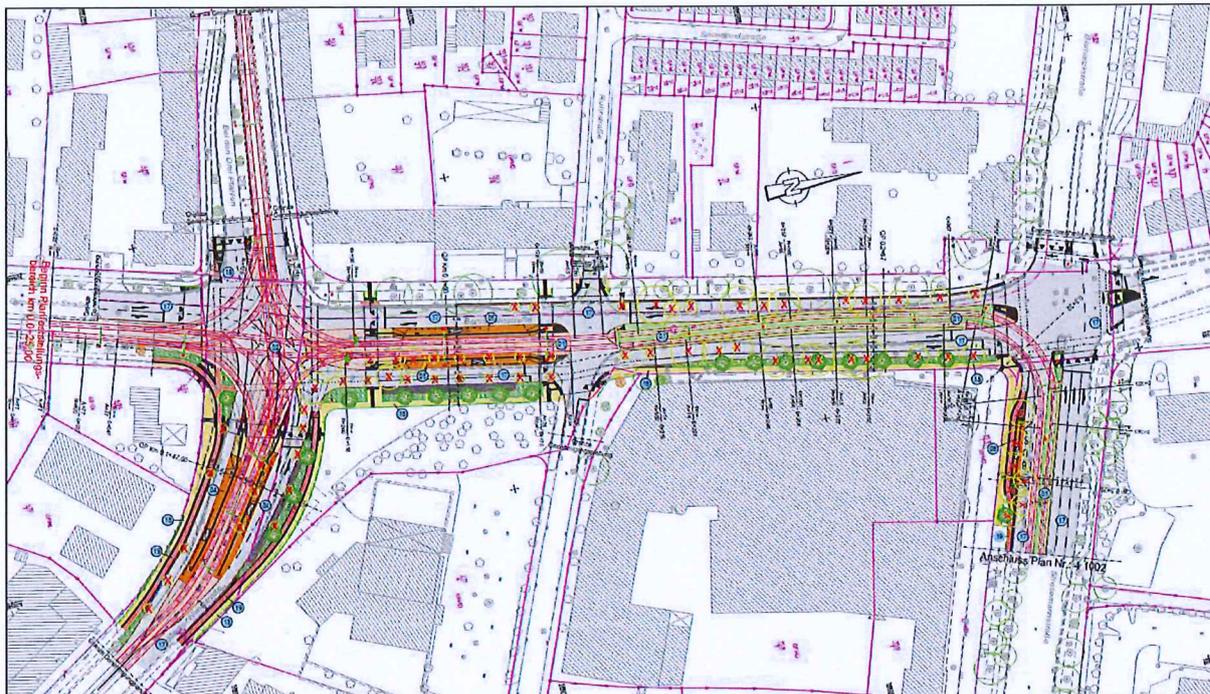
Lageplan Vorzugsvariante Bennisenstraße, Anschluss Stresemannstraße
